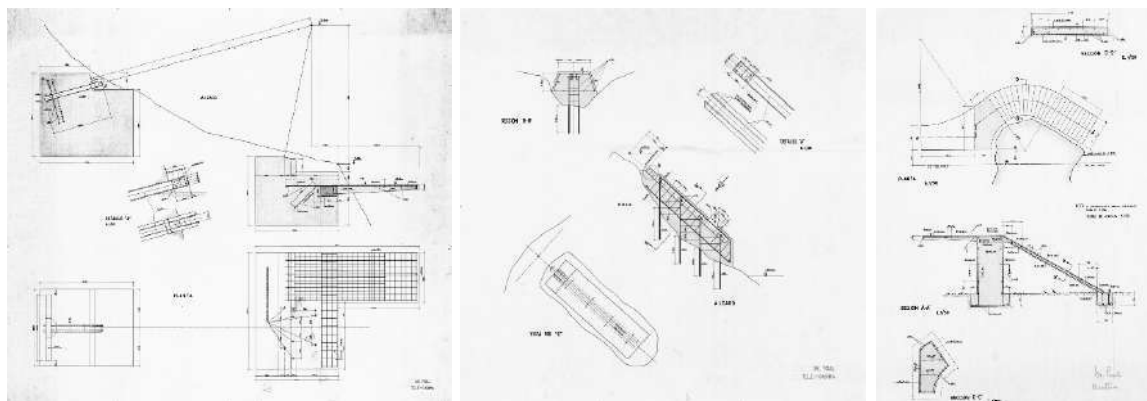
Alzado del armado de la viga. Fundación Bosch Aymerich.
